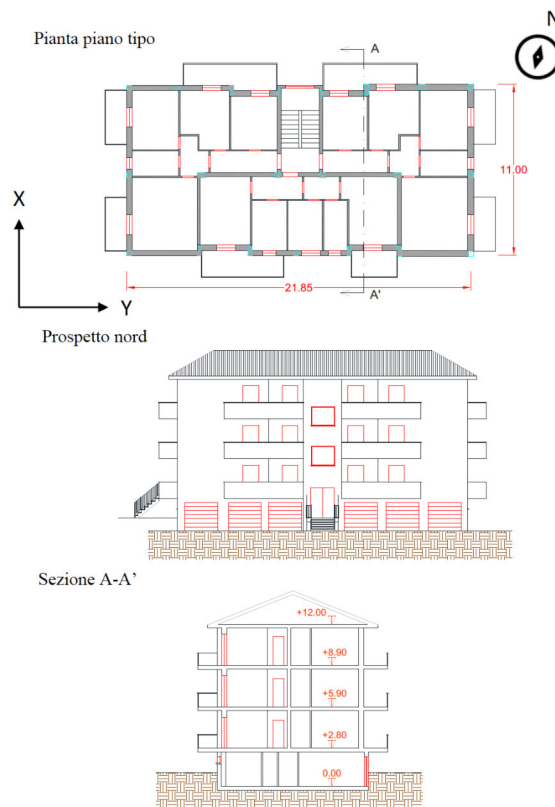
Pianta, prospetto e sezione Condominio Santarelli 2B
